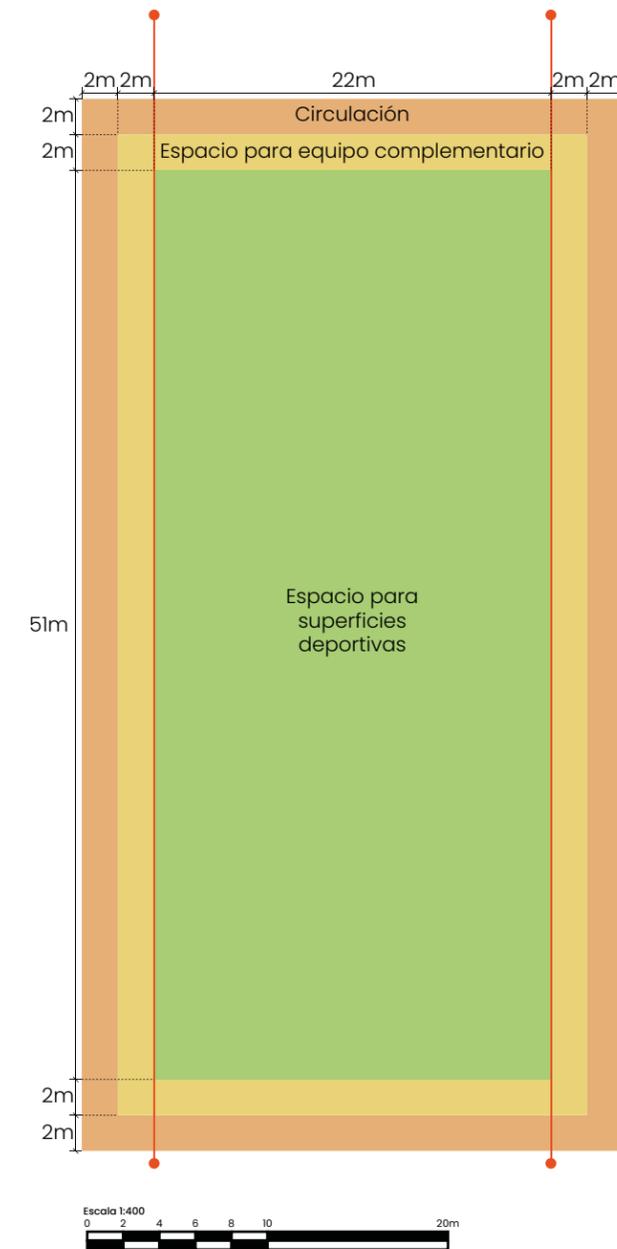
Dimensión del área de juego principal las graderías plegables retraídas. Escala 1:400. Elaboración propia.
